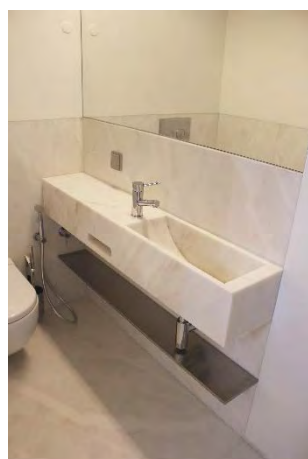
Revestimento da instalação a pedra de Vila Viçosa e Lavatório em bloco de mármore escavado
